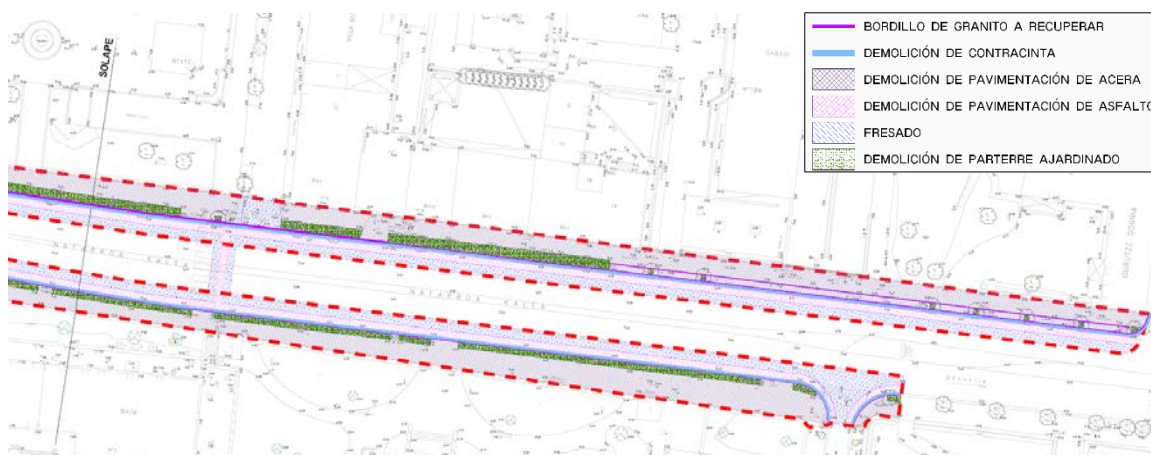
Plano de demolición en la zona oeste de Nafarroa kalea. 2/2
